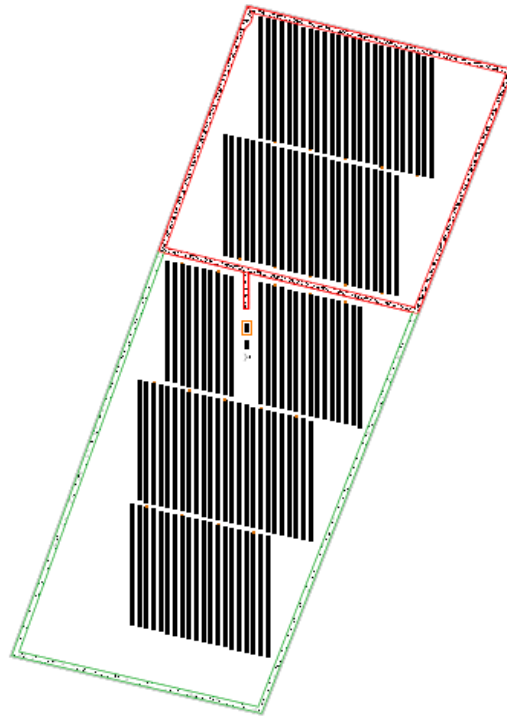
Plano de la planta solar fotovoltaica en Chillán, Chile.
